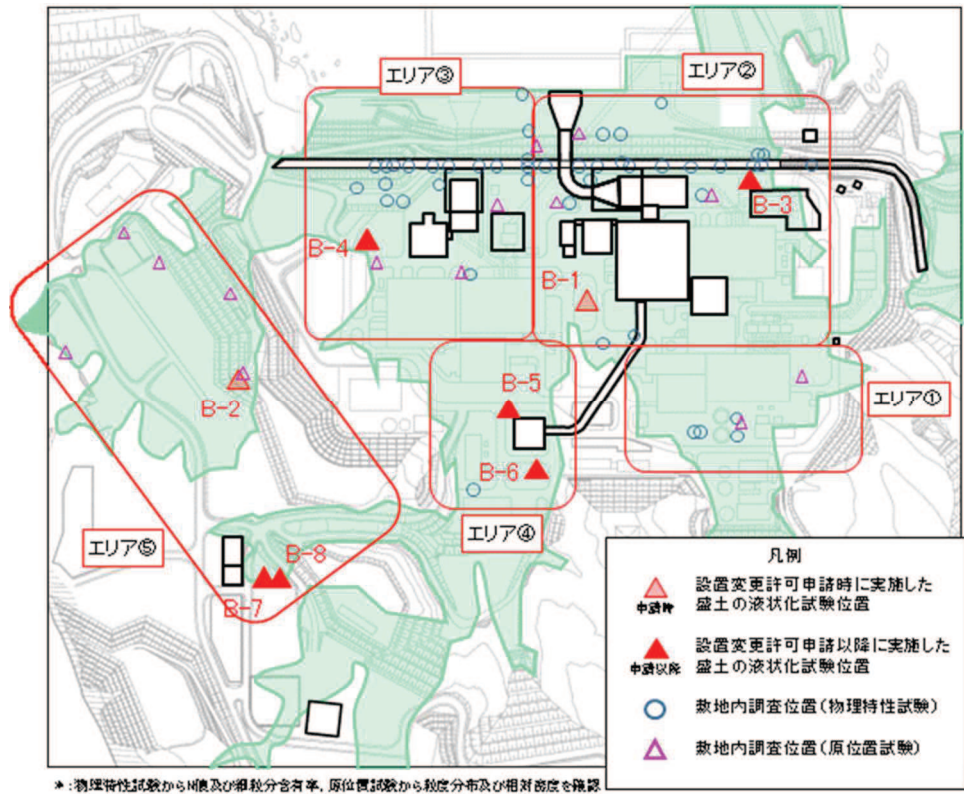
盛土の液状化強度試験位置及び敷地内調査位置の平面図
